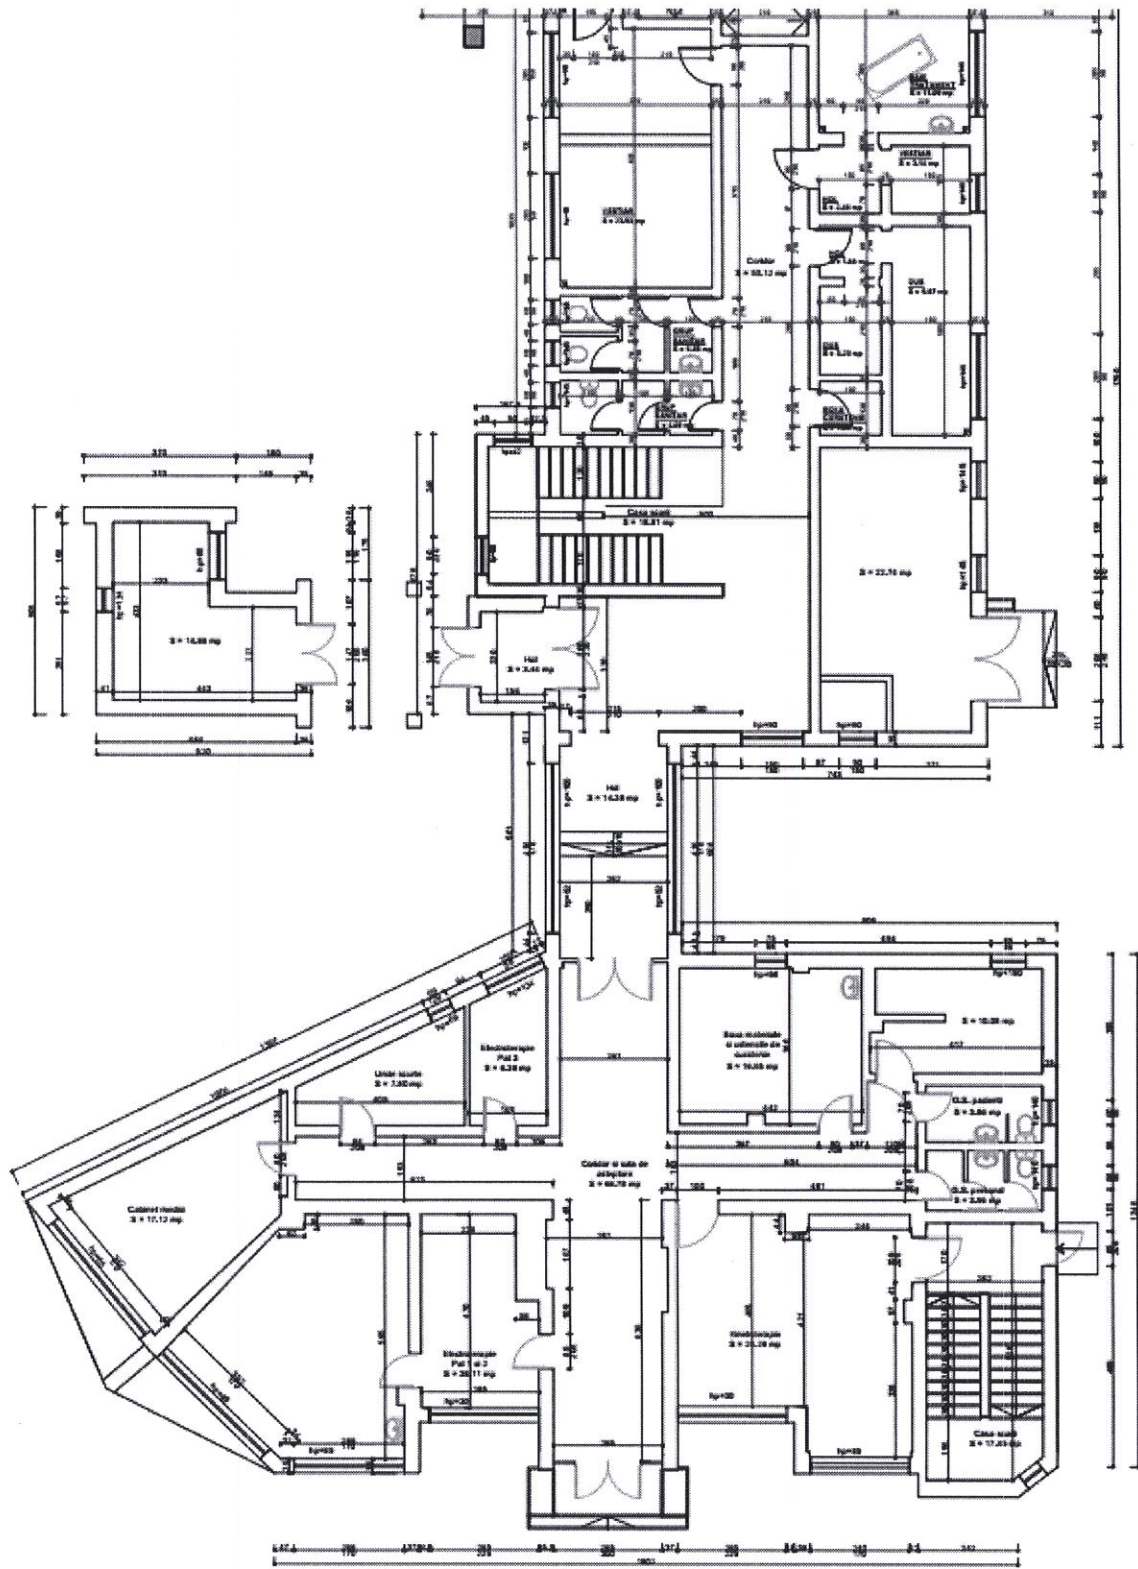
Plan parter existent Corp Tratamnte C1+C2
